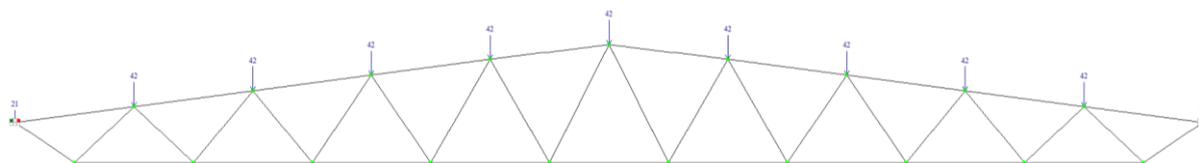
Розрахункова схема ферми у ПК ЛИРА САПР
